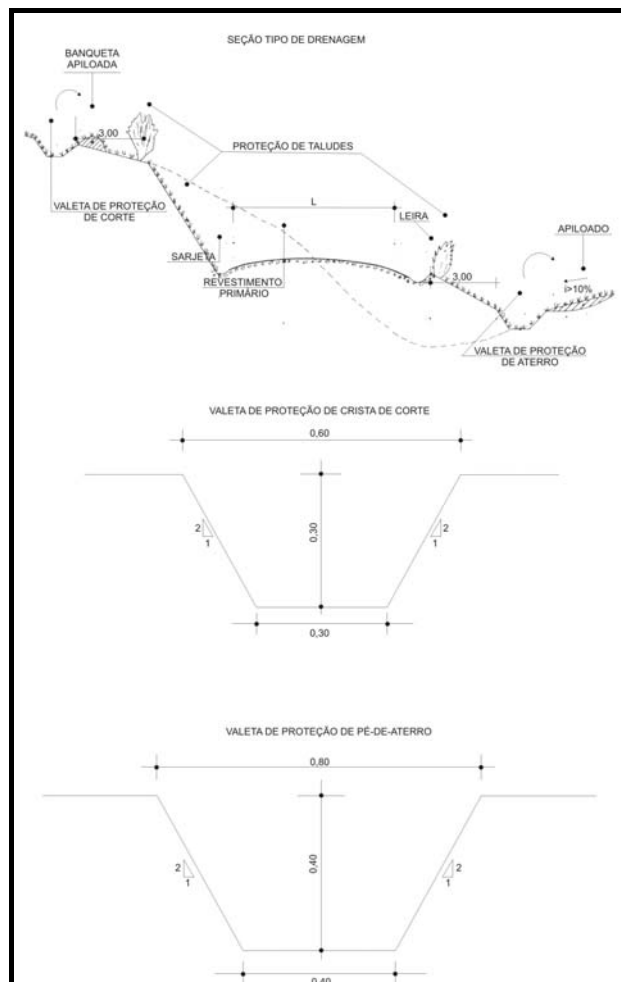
Modelo para valetas de proteção.
